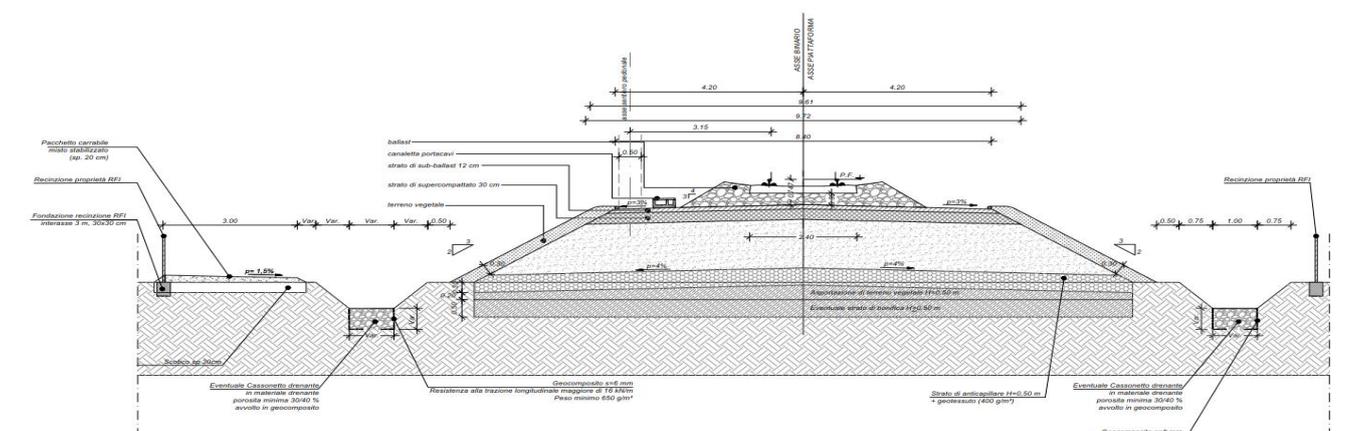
Sezione tipo ferroviaria in rilevato a singolo binario in rettilo
